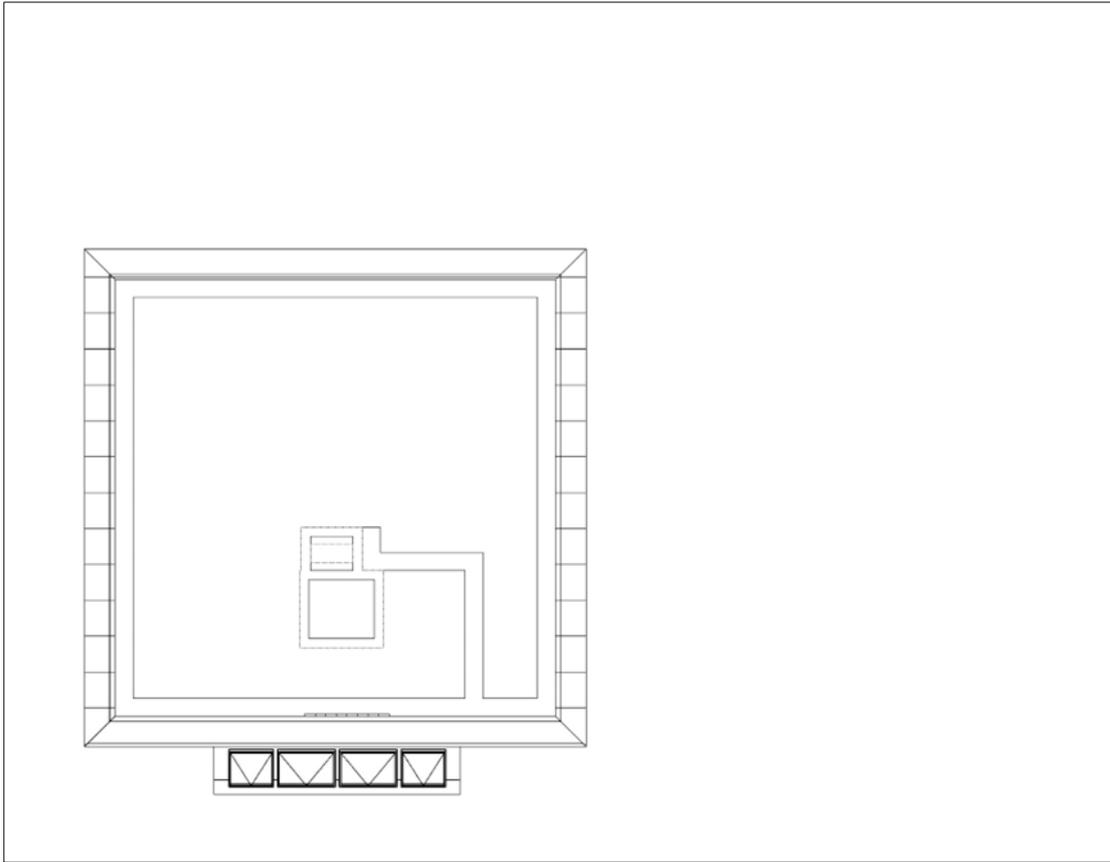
Fallbeispiel Grundriss Dach
